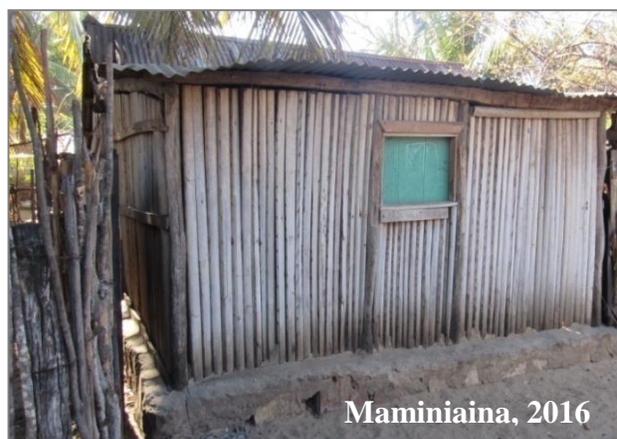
Maison traditionnelle fabriquée par des nervures des raphias
